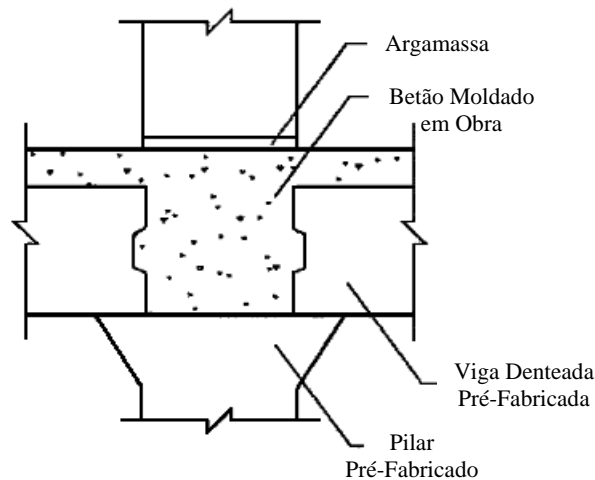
Ligação viga - pilar com betonagem da junta dos elementos, adaptado de [30]
